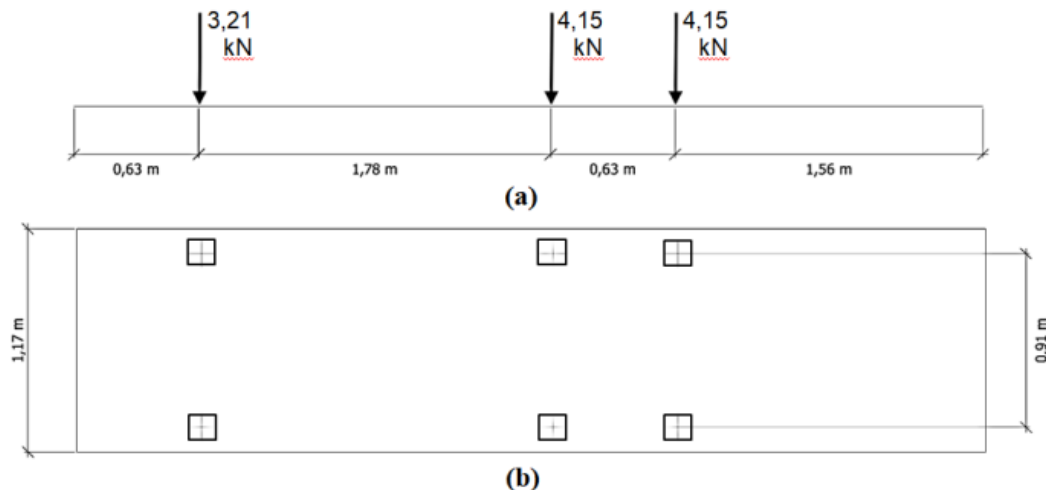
Esquema do veículo e dimensões do modelo reduzido: (a) em elevação, (b) em planta
